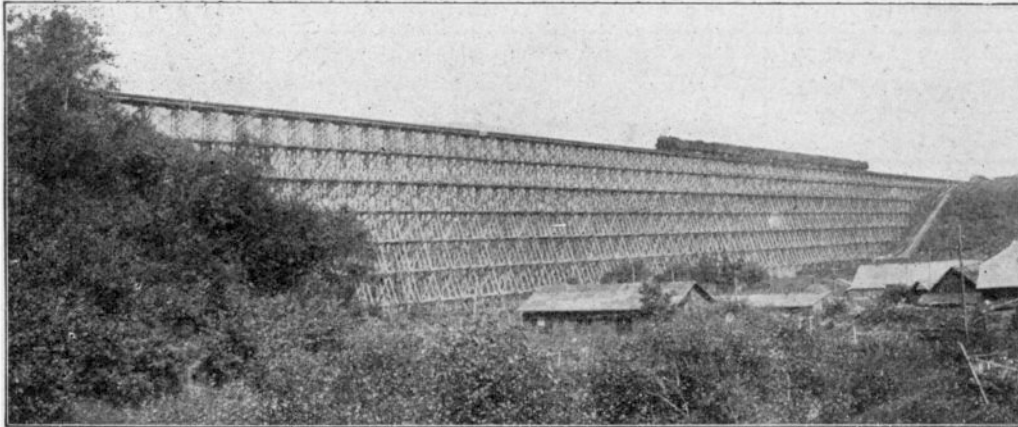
Ansicht der hölzernen Dubissabrücke.
